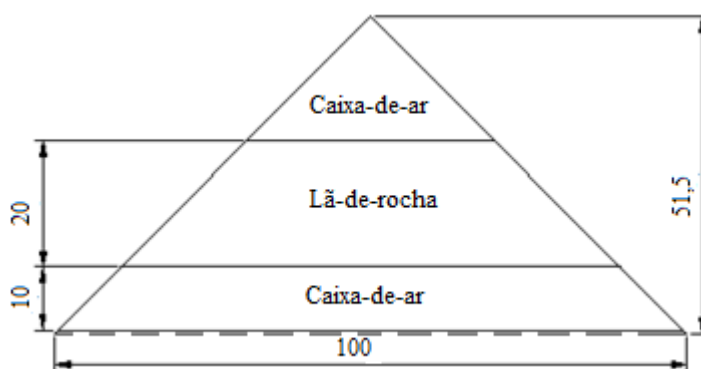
Dimensões [cm] em planta: painel perfurado com lã-de-rocha de 200 mm (P200)
